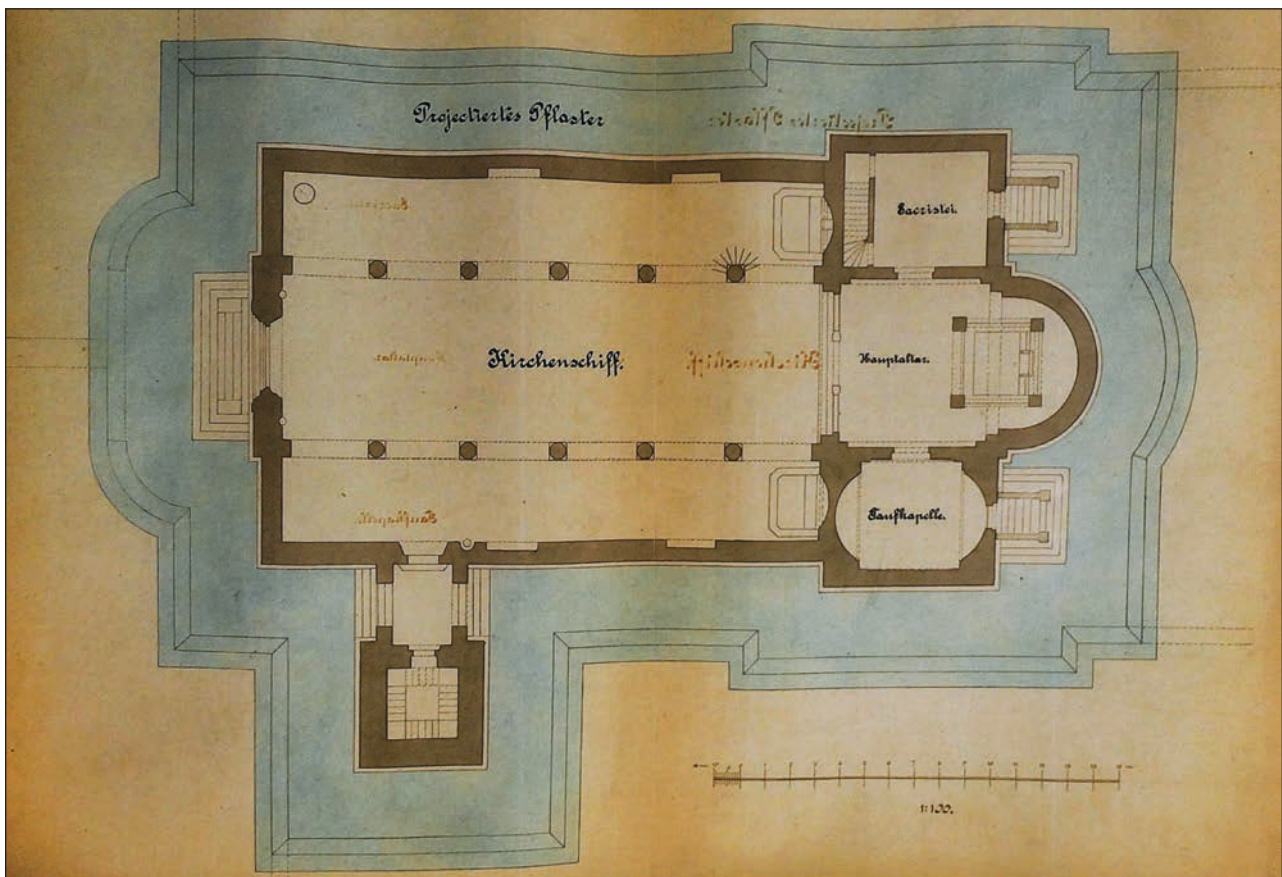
Grundriss „Madonna del Mare“ (ÖStA, SR-KB; Foto: B. Mader).
